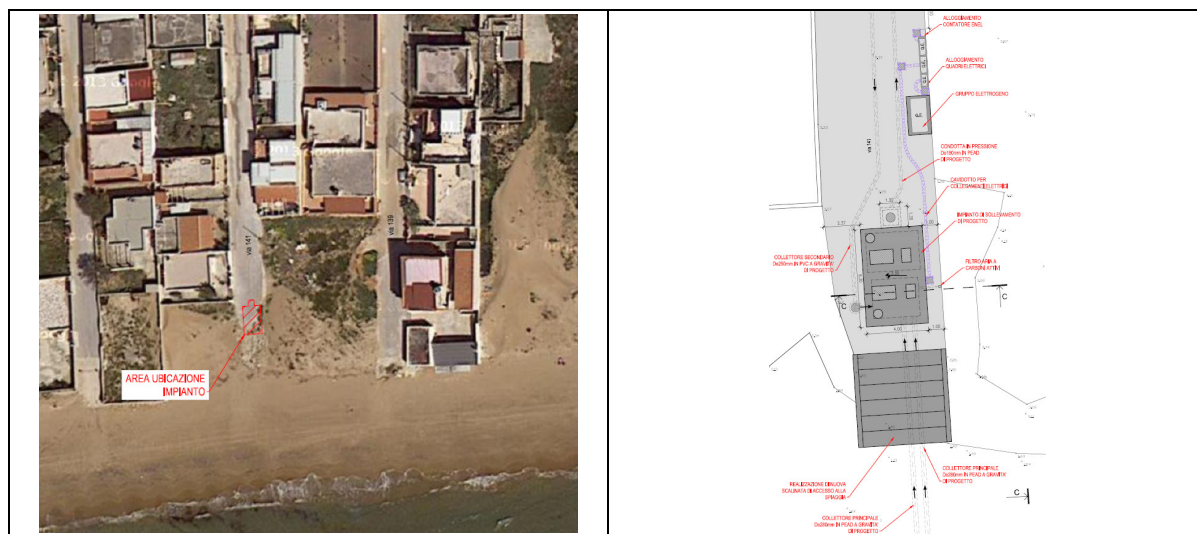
Localizzazione territoriale dell'impianto e planimetria con le sistemazioni previste.
